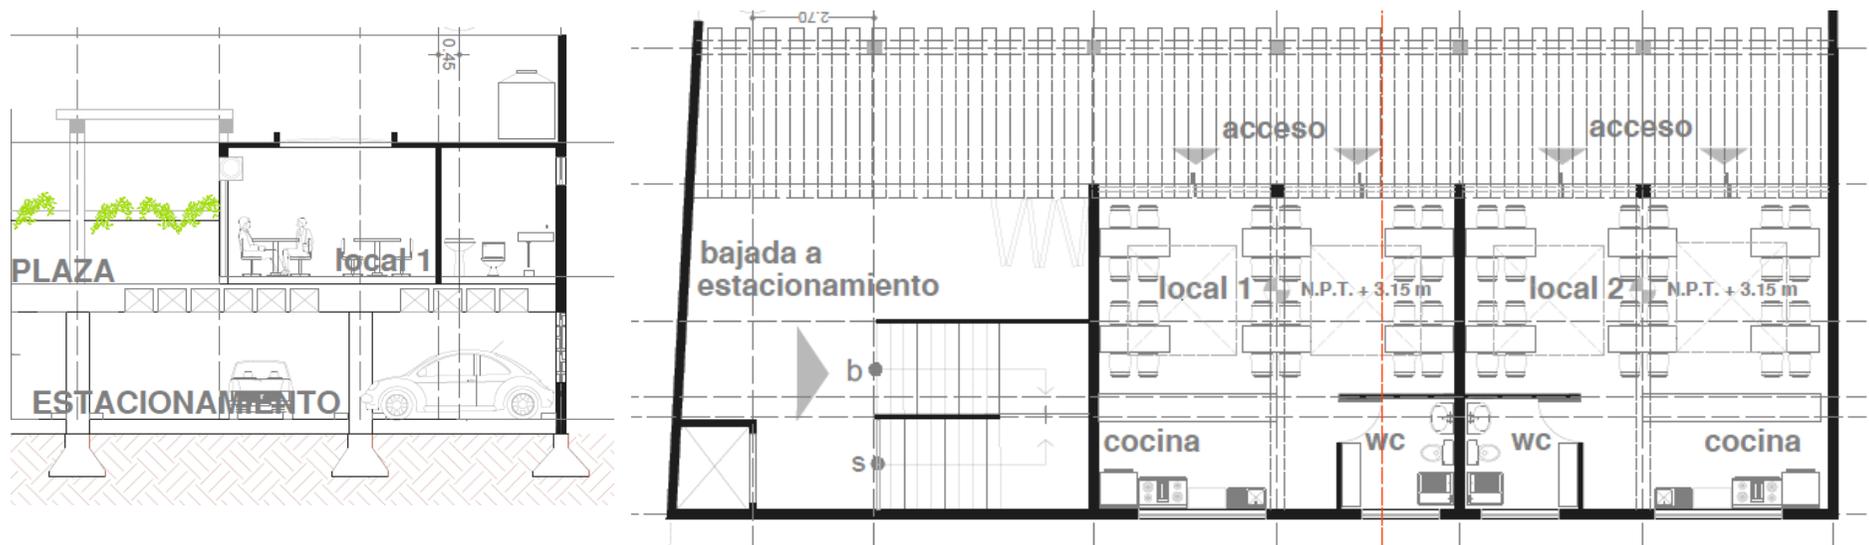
Corte y planta de los locales de comercio. Ver planos en anexo. Págs. 224 a 230.
